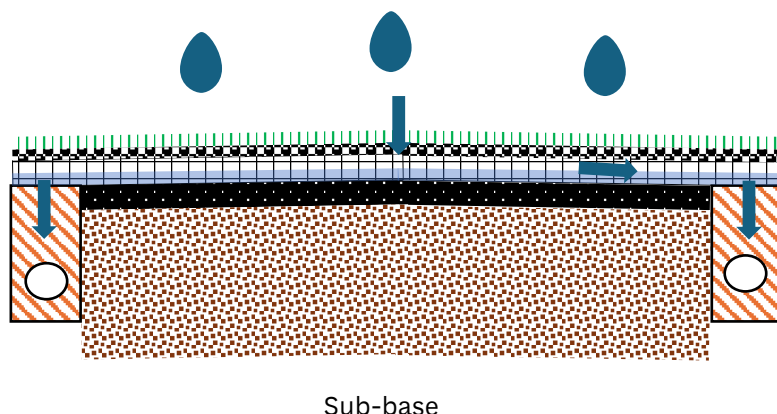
Sistema de drenaje subterráneo típico utilizado en construcciones de campo con drenaje vertical. También se utilizan otras configuraciones de zanjas de drenaje.
